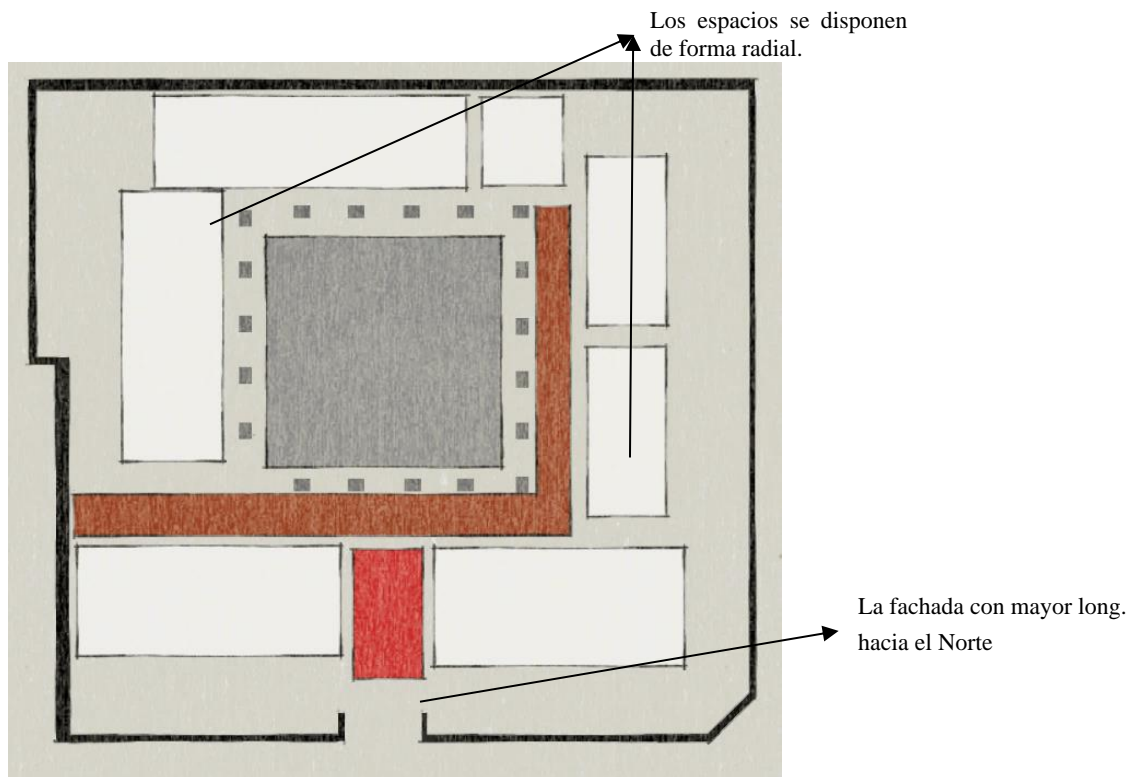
Figura VII Orientación de fachada con mayor longitud hacia el Norte o Sur usando una organización radial en el objeto arquitectónico.
